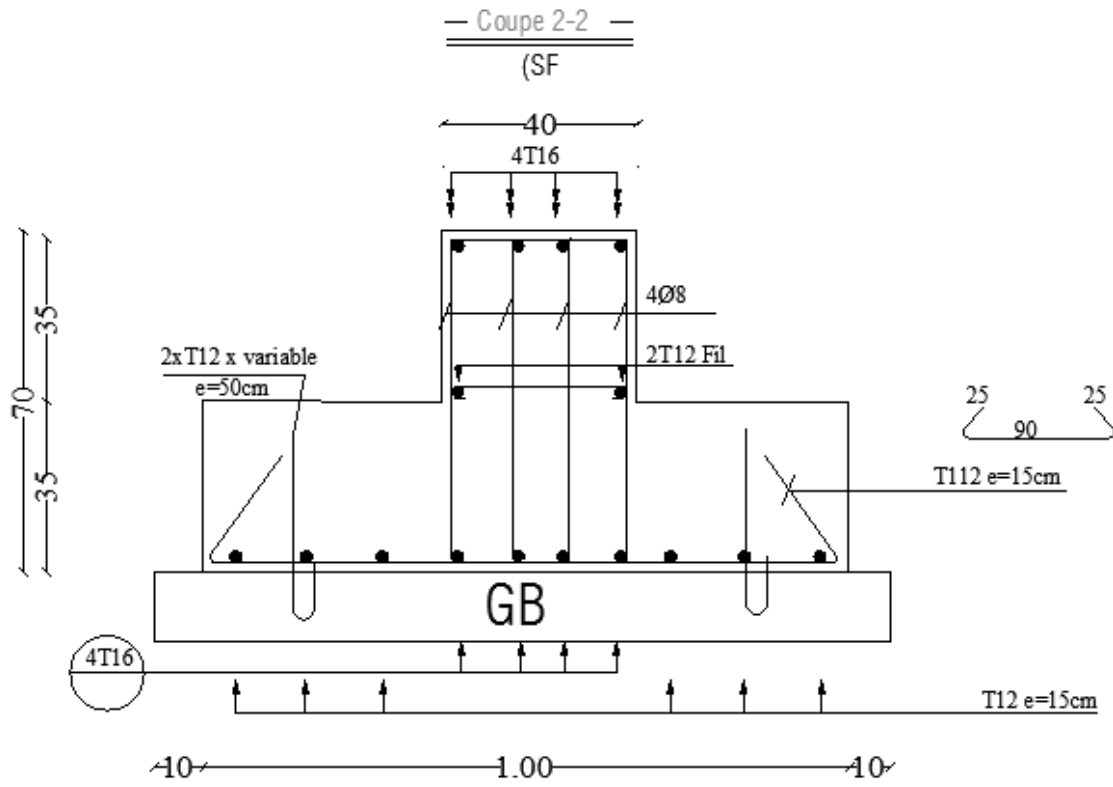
schéma de ferrailage des semelles aux appuis.
